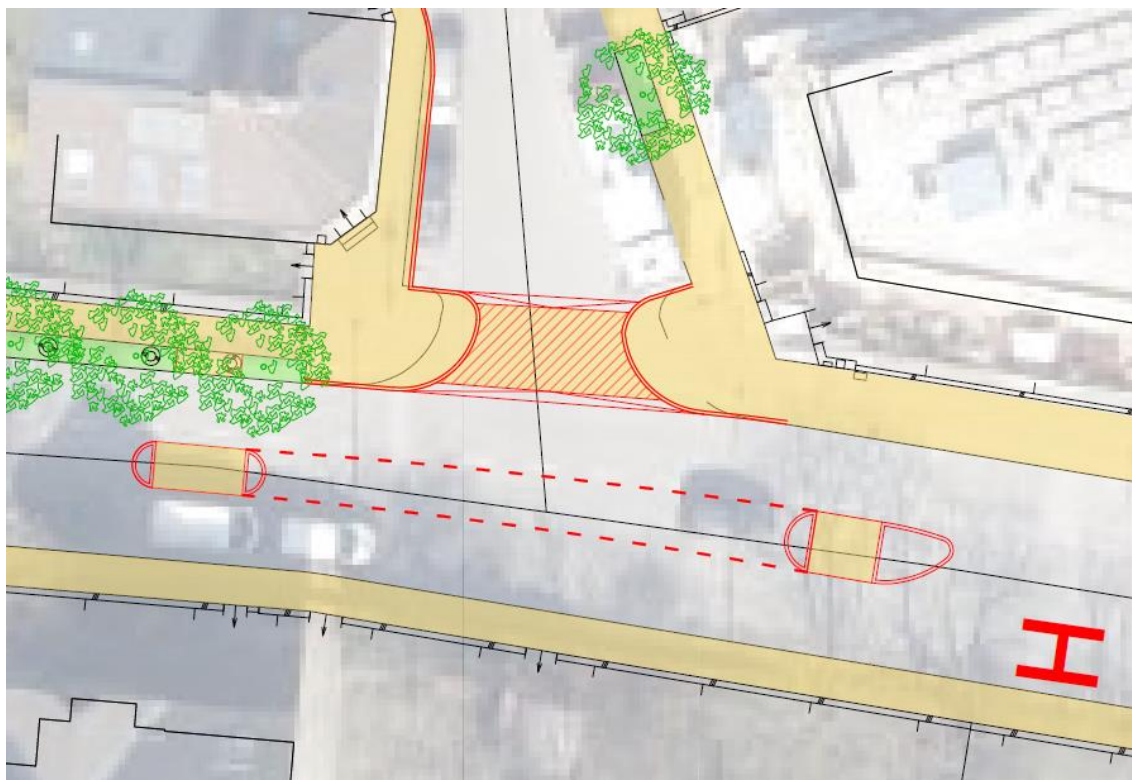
Ausschnitt Planungsvariante 3 Friedrich Schiller-Straße # Eisentorgasse
